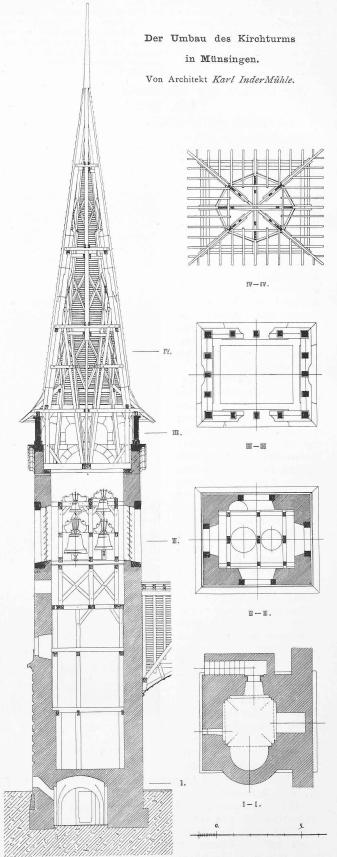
Schnitt und Grundrisse. — Masstab I: 200.
